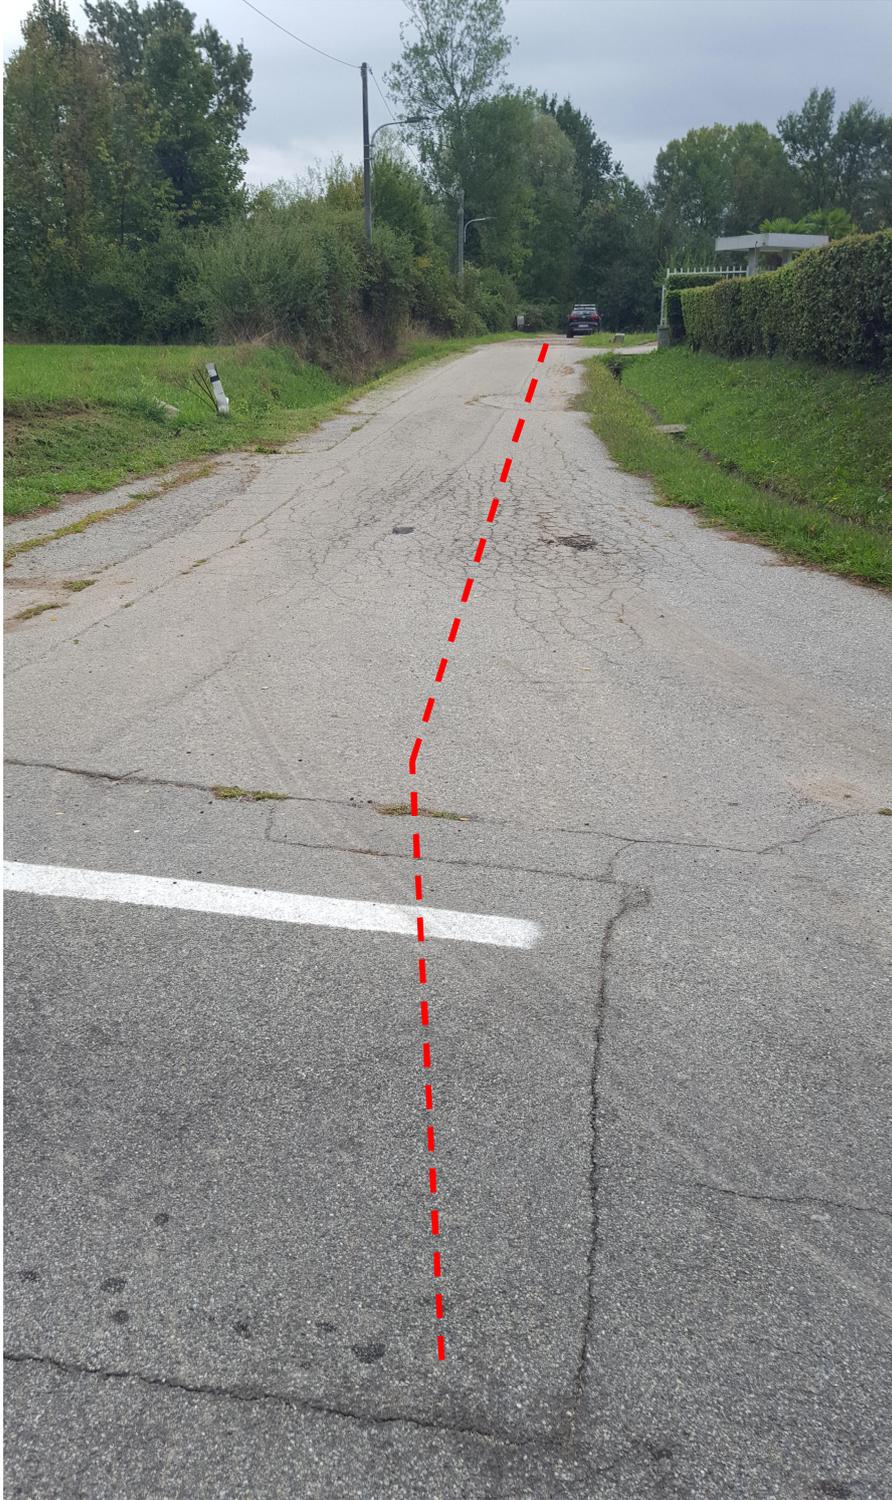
tracciato tratto sostituzione tubazione dalla via Saini
